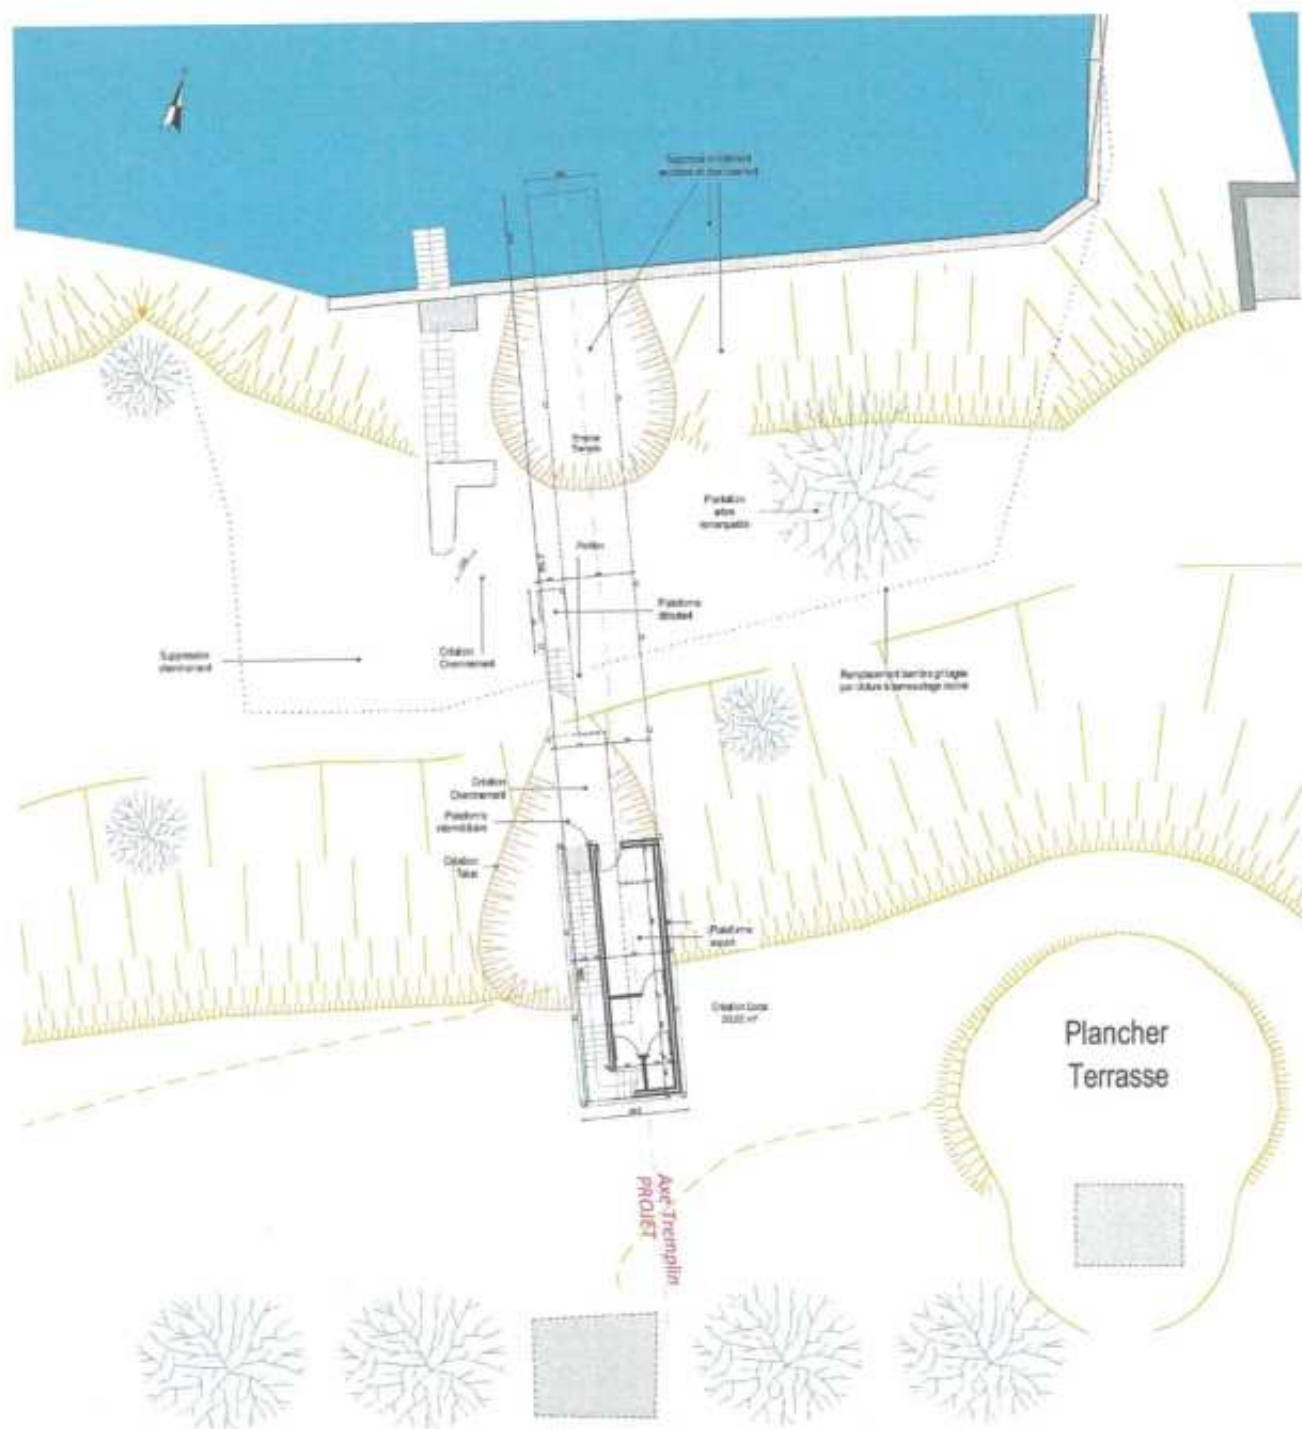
Plan du projet (©Atelier d'Architecture Imagine) - échelle 1/250
